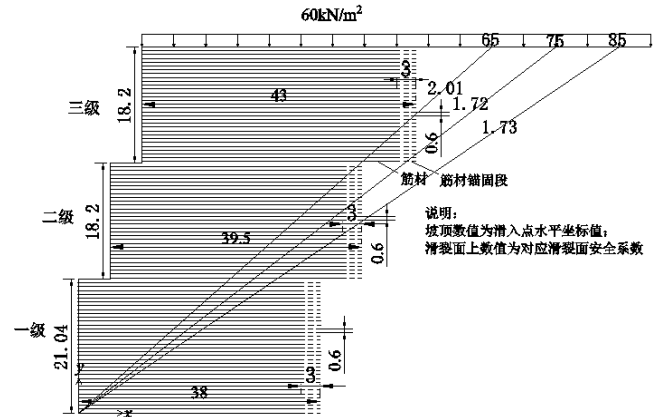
重庆奉节三马山 57m 加筋土挡墙简化剖面图
